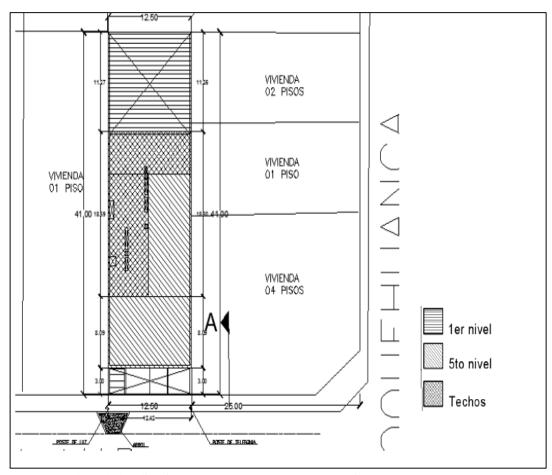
Plano de localización con corte. Fuente: Autoría propia.
